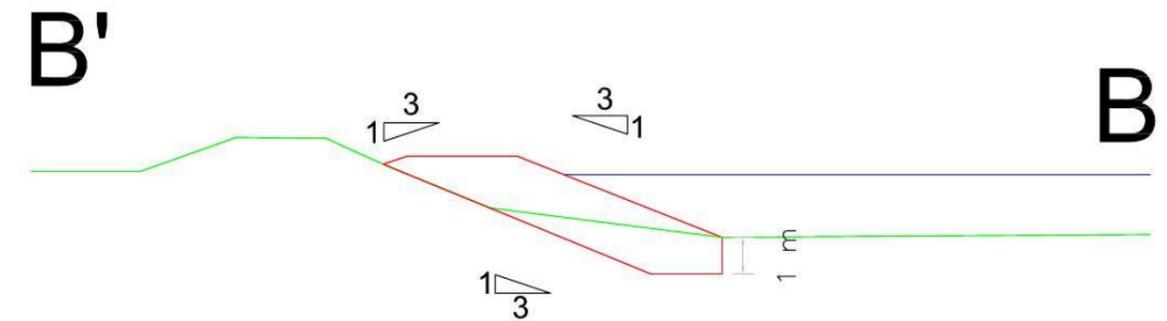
Coupe schématique du principe d'ancrage de l'ouvrage Aval (coupe BB')
